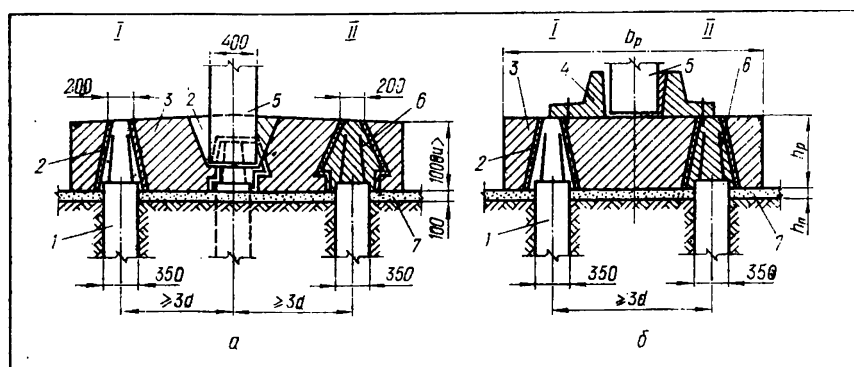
Конструкция свайного ростверка для путепроводов и эстакад при поэтапном нагружении:
